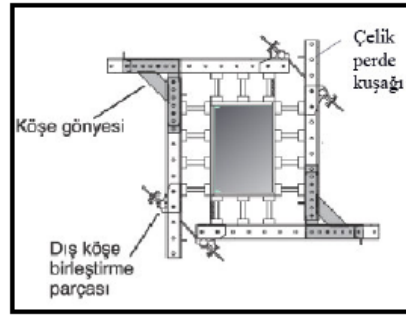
Ayarlanabilir çerçeve kalıp planı [9]
